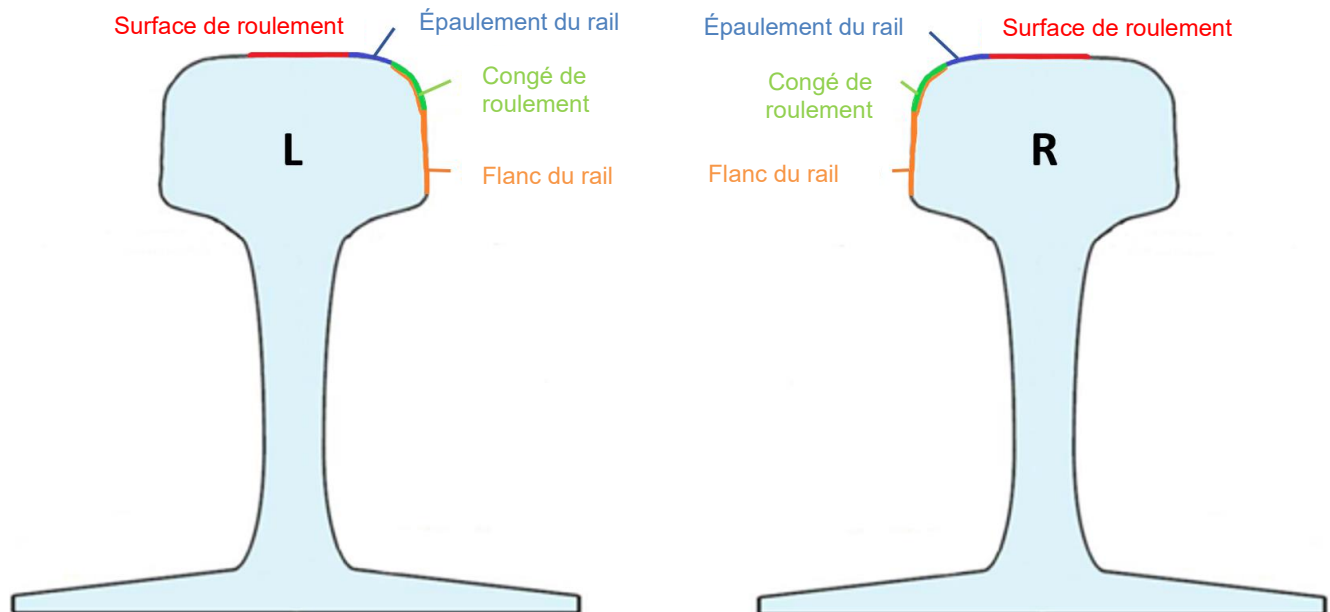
Coupe transversale du rail (L : rail gauche, R : rail droit)
